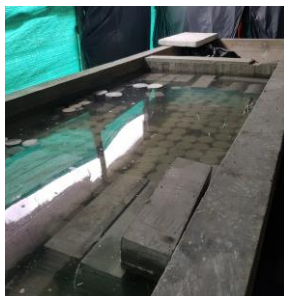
Piscina para prueba de absorción de los bloques en concreto / Imagen 76. Murete en bloque de concreto para prueba de resistencia
